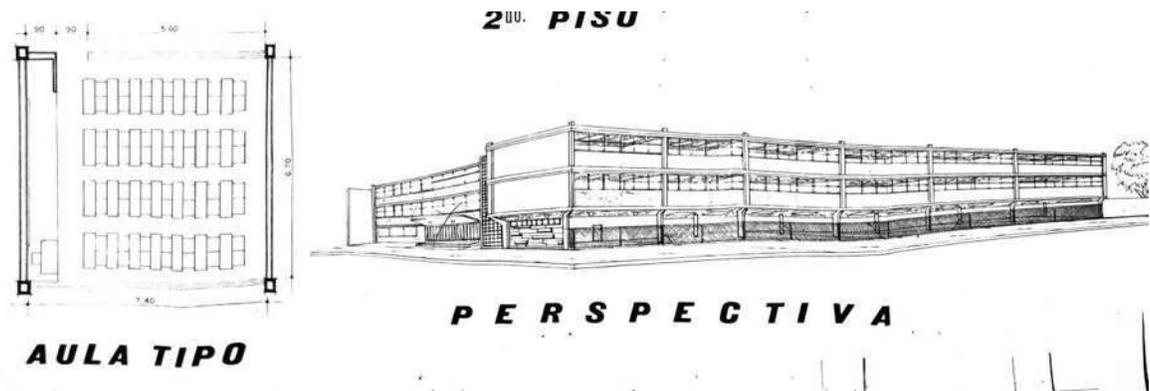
Planimetría 2 escuela Apolonio M. Avilés.
